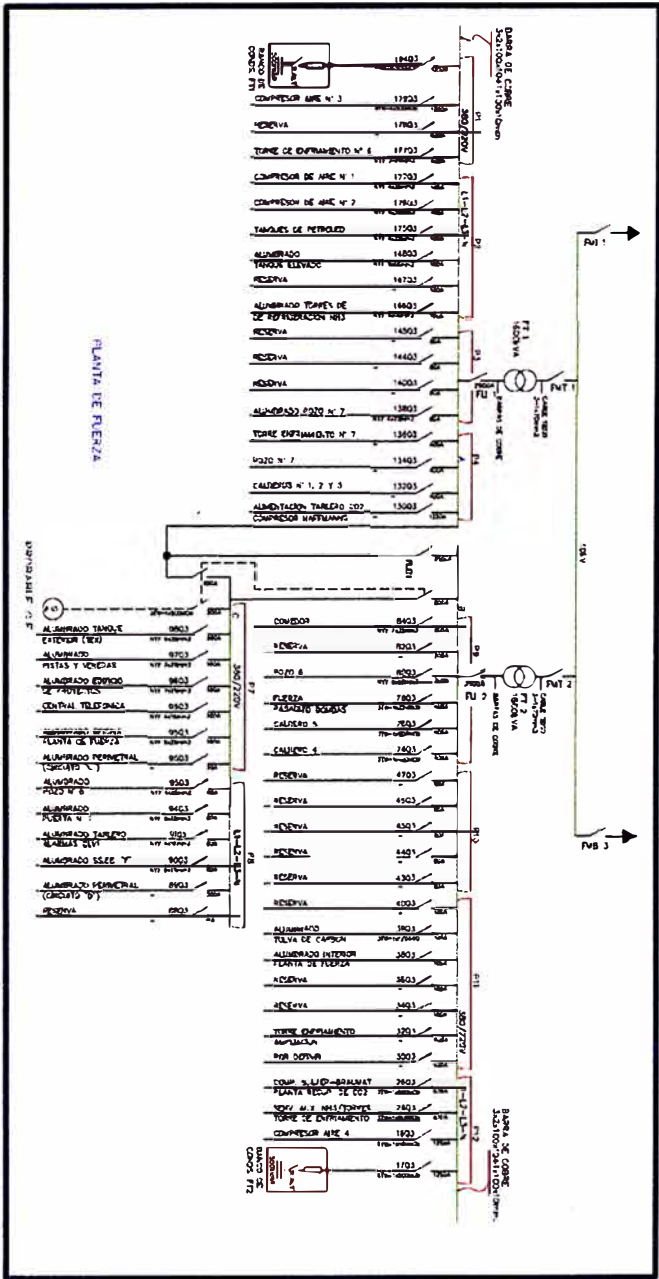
Subestación eléctrica F2 (Planta de Fuerza2)
